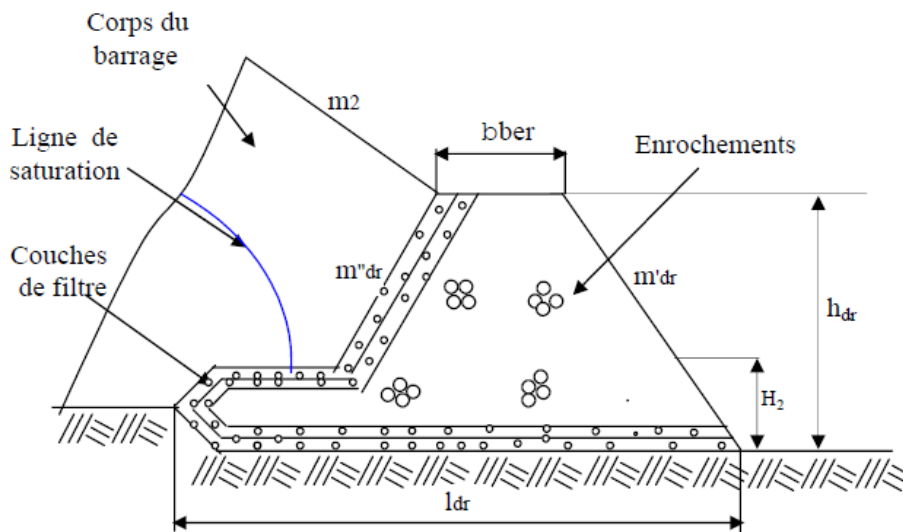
Prisme de drainage avec drain tapis interne sur fondations perméables.
